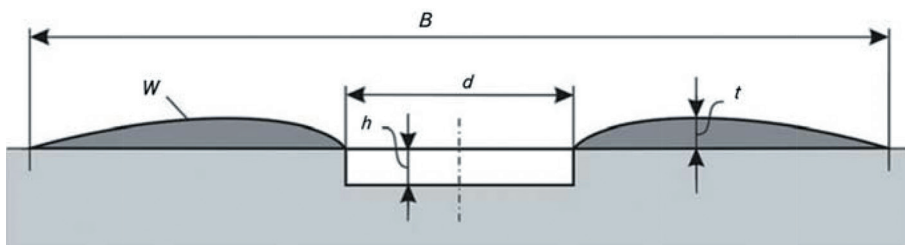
Прямоугольное поперечное сечение ПМП: B — ширина полосы, d — ширина выемки, h — глубина выемки, W — грунт из выемки, t — толщина слоя грунта из выемки
